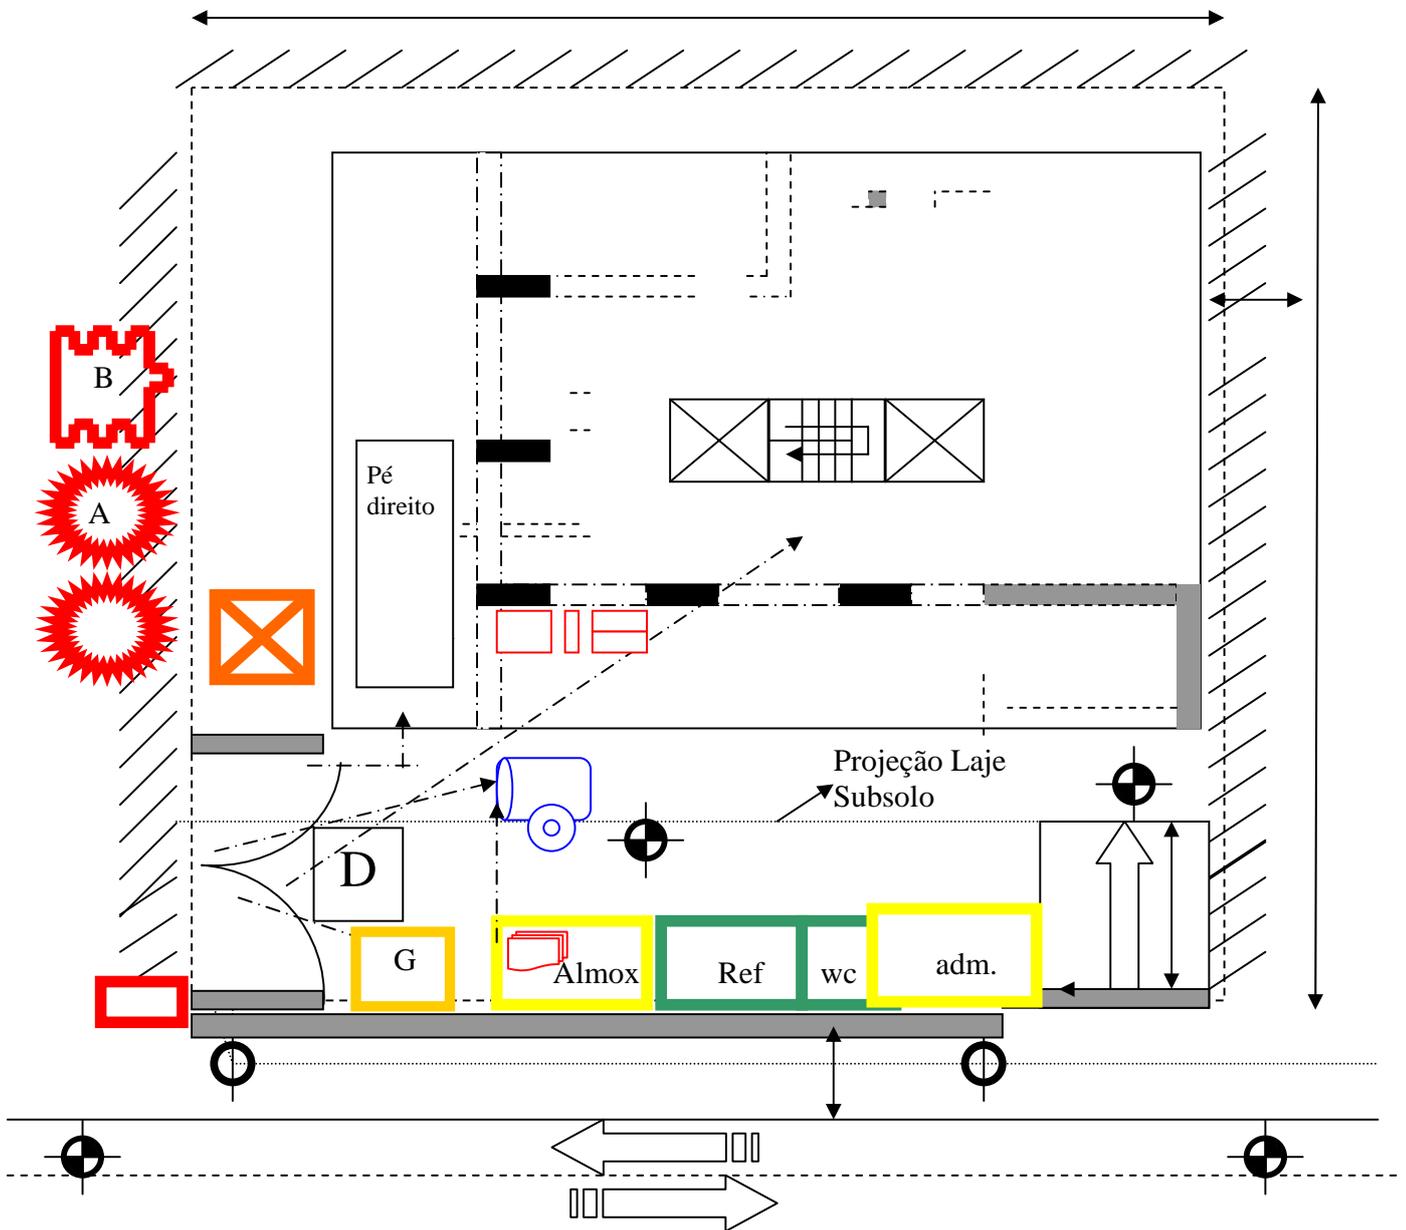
Layout do canteiro de obras visitado – Laje Térreo
